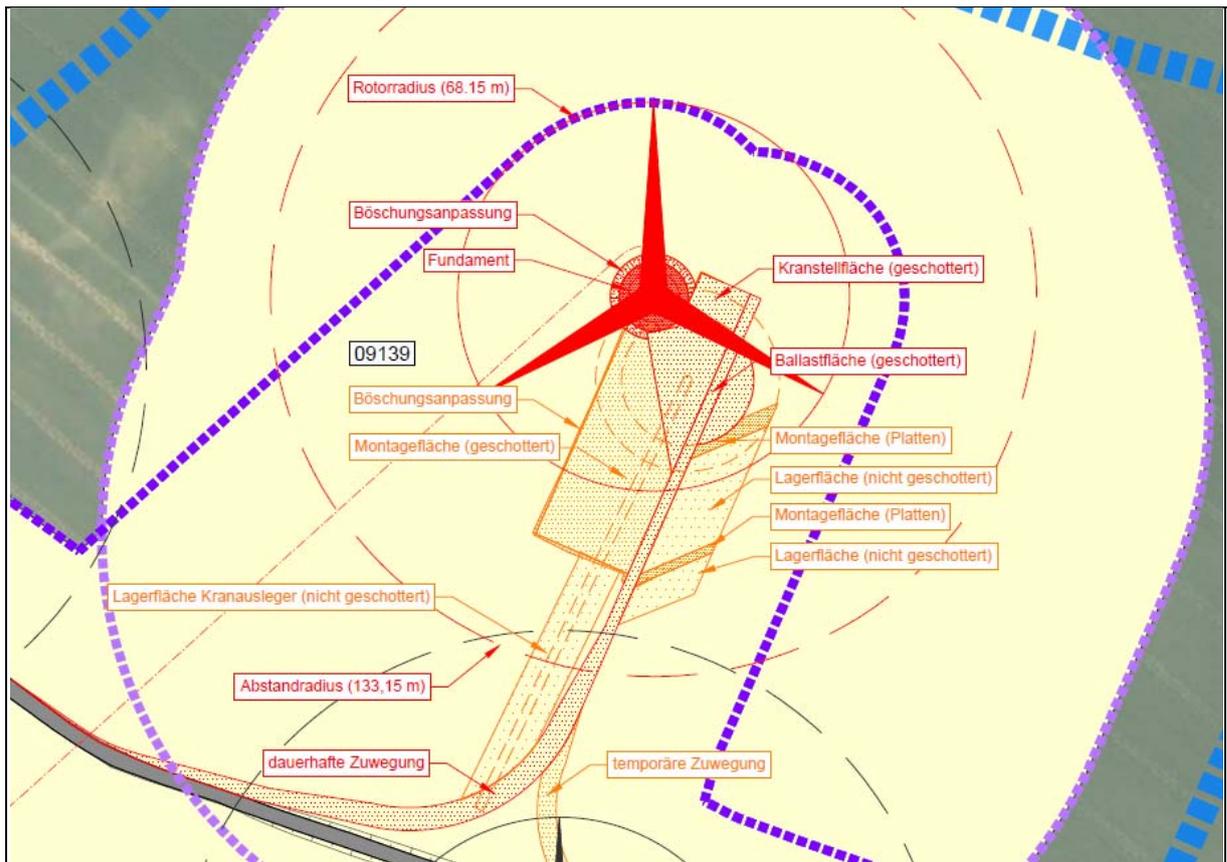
geplante WEA-Bauflächen (Auszug aus dem Bestands- und Konfliktplan)
